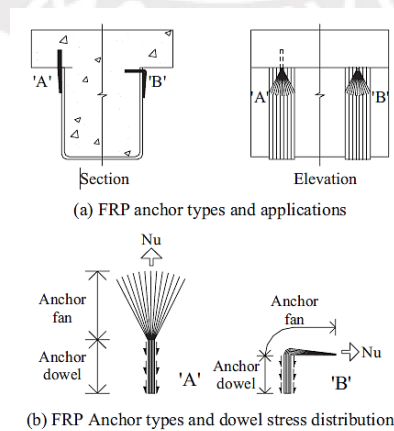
Anclajes de FRP en refuerzos a corte con bandas en U (Fuente: Kim & Smith, 2015)
